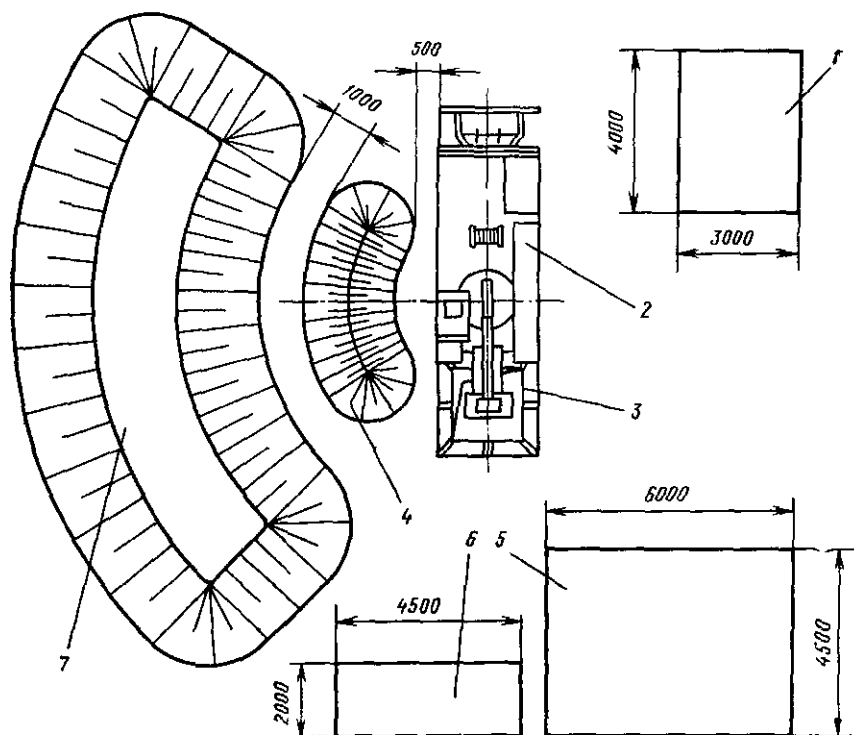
Схема оборудования рабочей площадки при проходке шурфа грейферной установкой УГШН-15:
